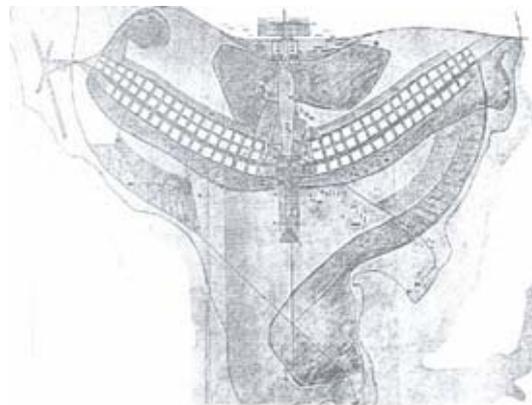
Planta geral do Plano Piloto de Lúcio Costa, de 1957
